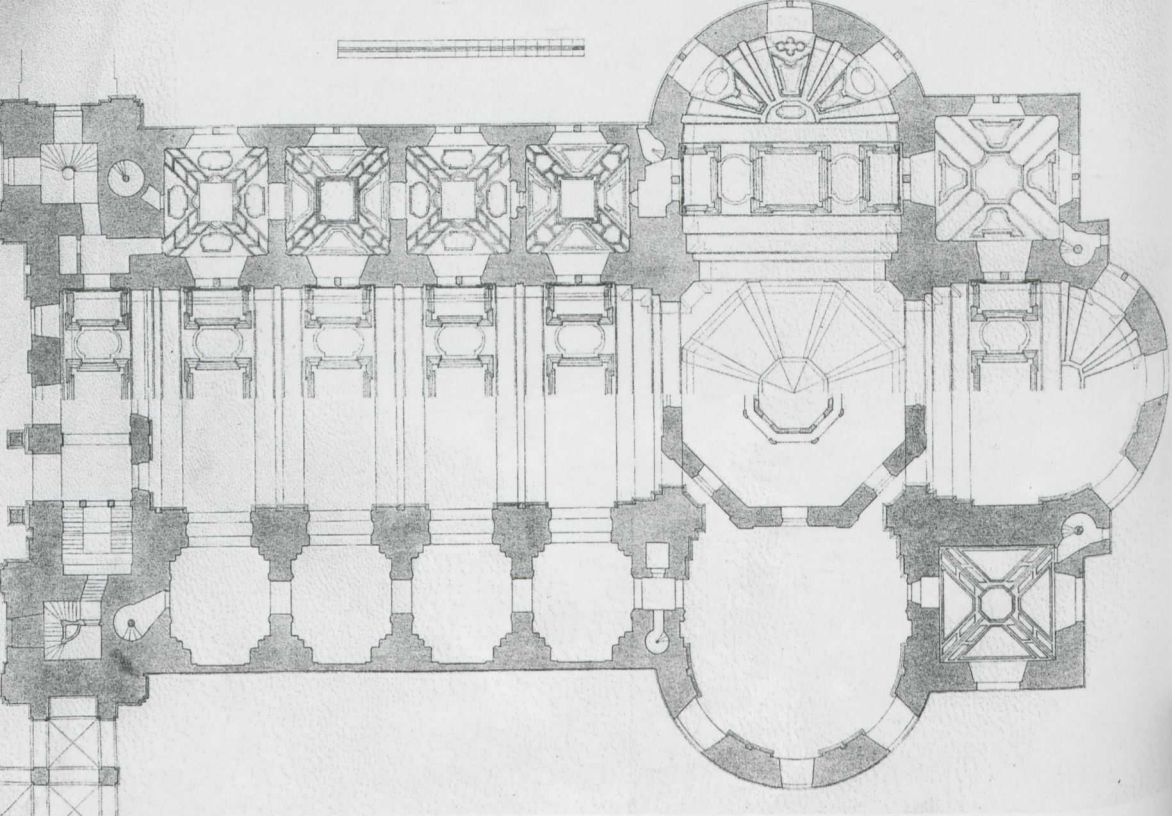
Salzburg, Domkirche St. Rupert und Virgil, Grundriß, aus: TIETZE (Anm. 116) Tafel I.
